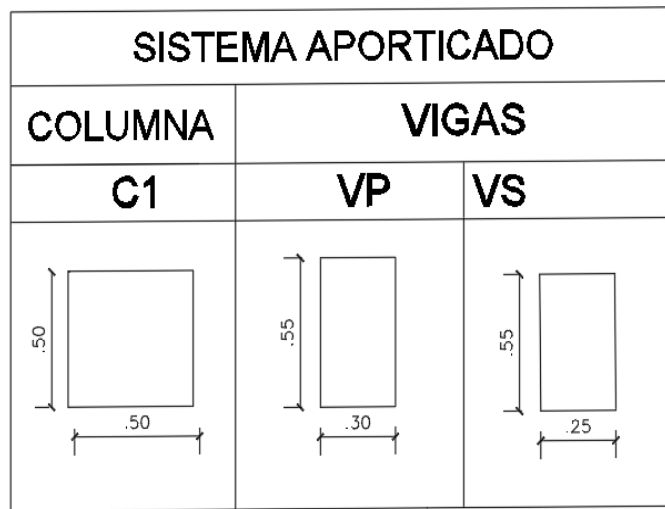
Secciones de vigas y columnas usadas para el modelado estructural del sistema Aporticado.
